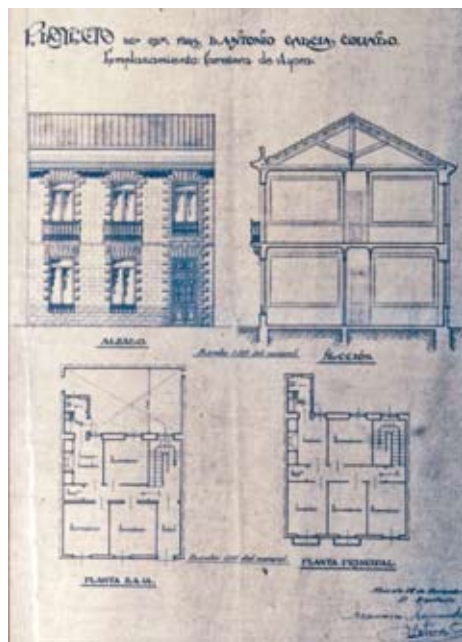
Alzado, sección y plantas Carretera de Ayora, 1924.
